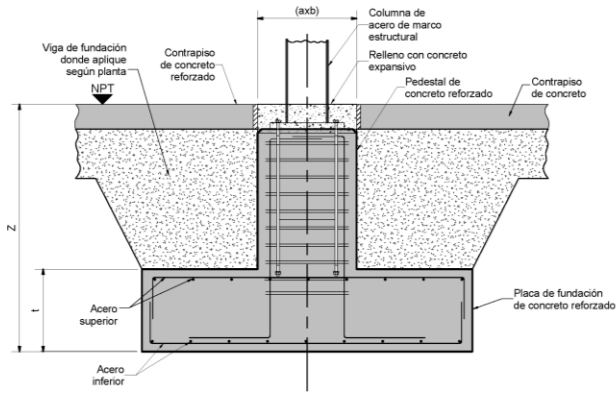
Detalle típico de placa aislada - Elaboración propia, 2024
